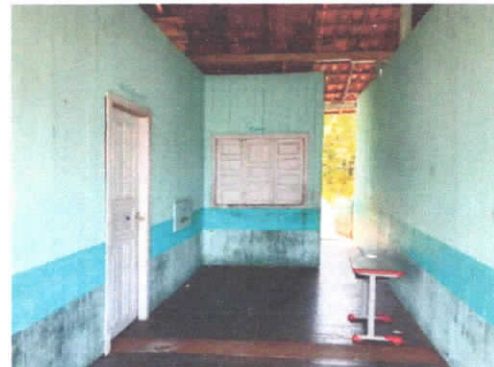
VISTA DE ACESSO A SECRETARIA, COZINHA E FUNDOS DA ESCOLA.
